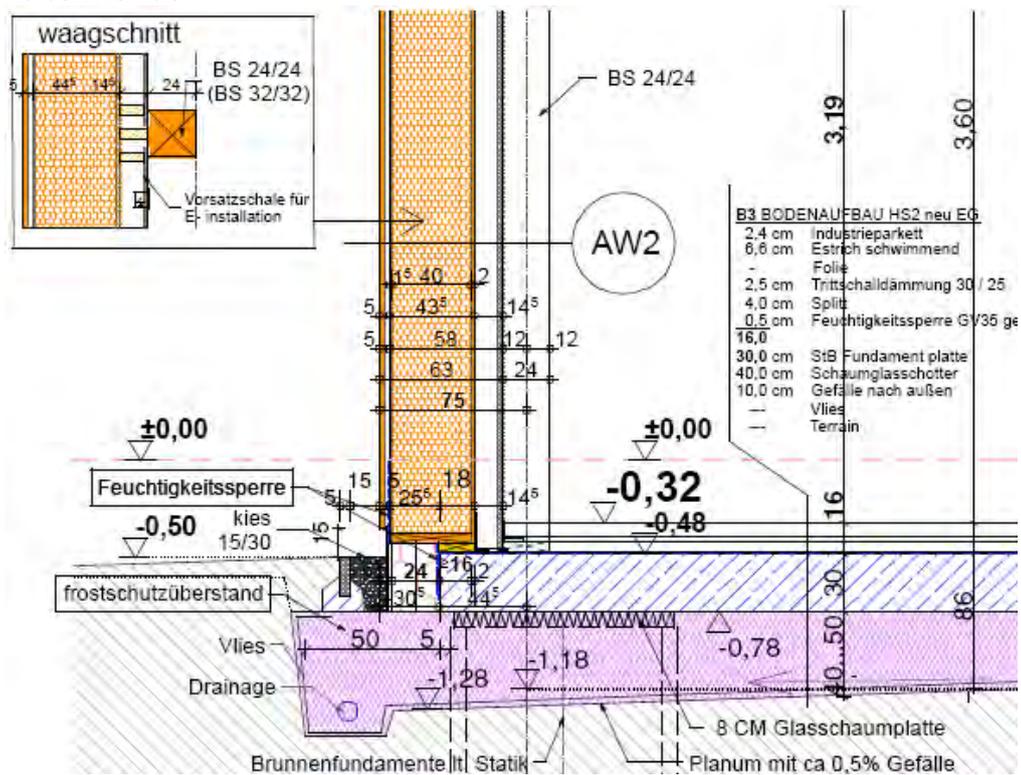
Sockeldetail Polytechnische Schule Zubau
